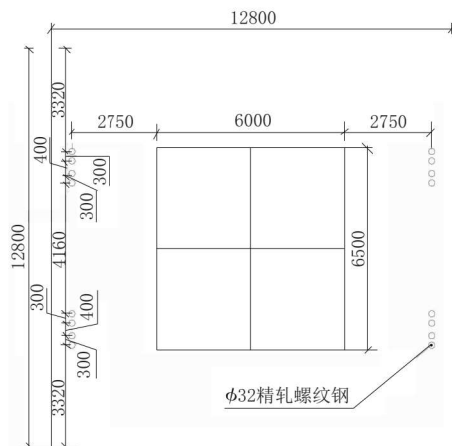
精轧螺纹钢预埋平面布置图(单位:mm)
